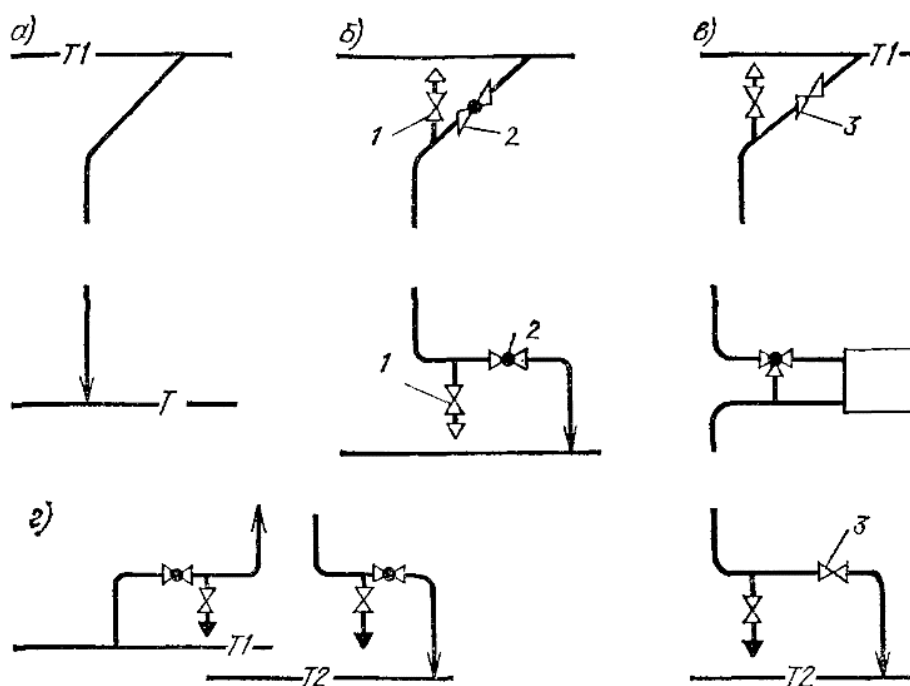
Схемы присоединения стояков к магистралям систем водяного отопления двух-трехэтажных (а), четырех-семиэтажных при верхней разводке (б) и нижней разводке (г), восьмиэтажных и более высоких (в) зданий: 1 – спускной кран (внизу – со штуцером); 2 – запорный кран; 3 – запорный вентиль
